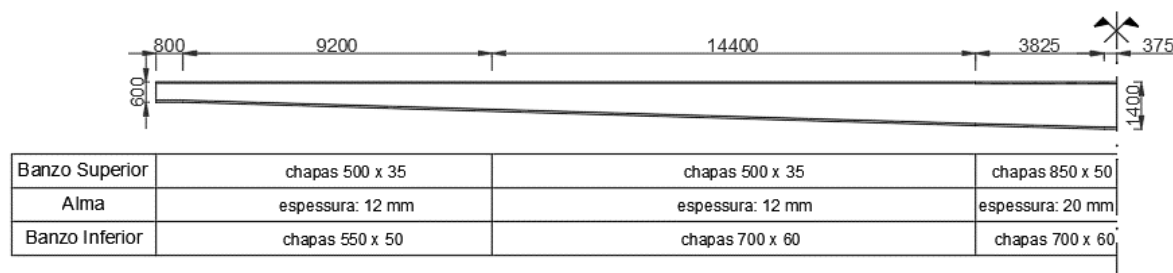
Geometria das vigas metálicas principais (dimensões em milímetros)
